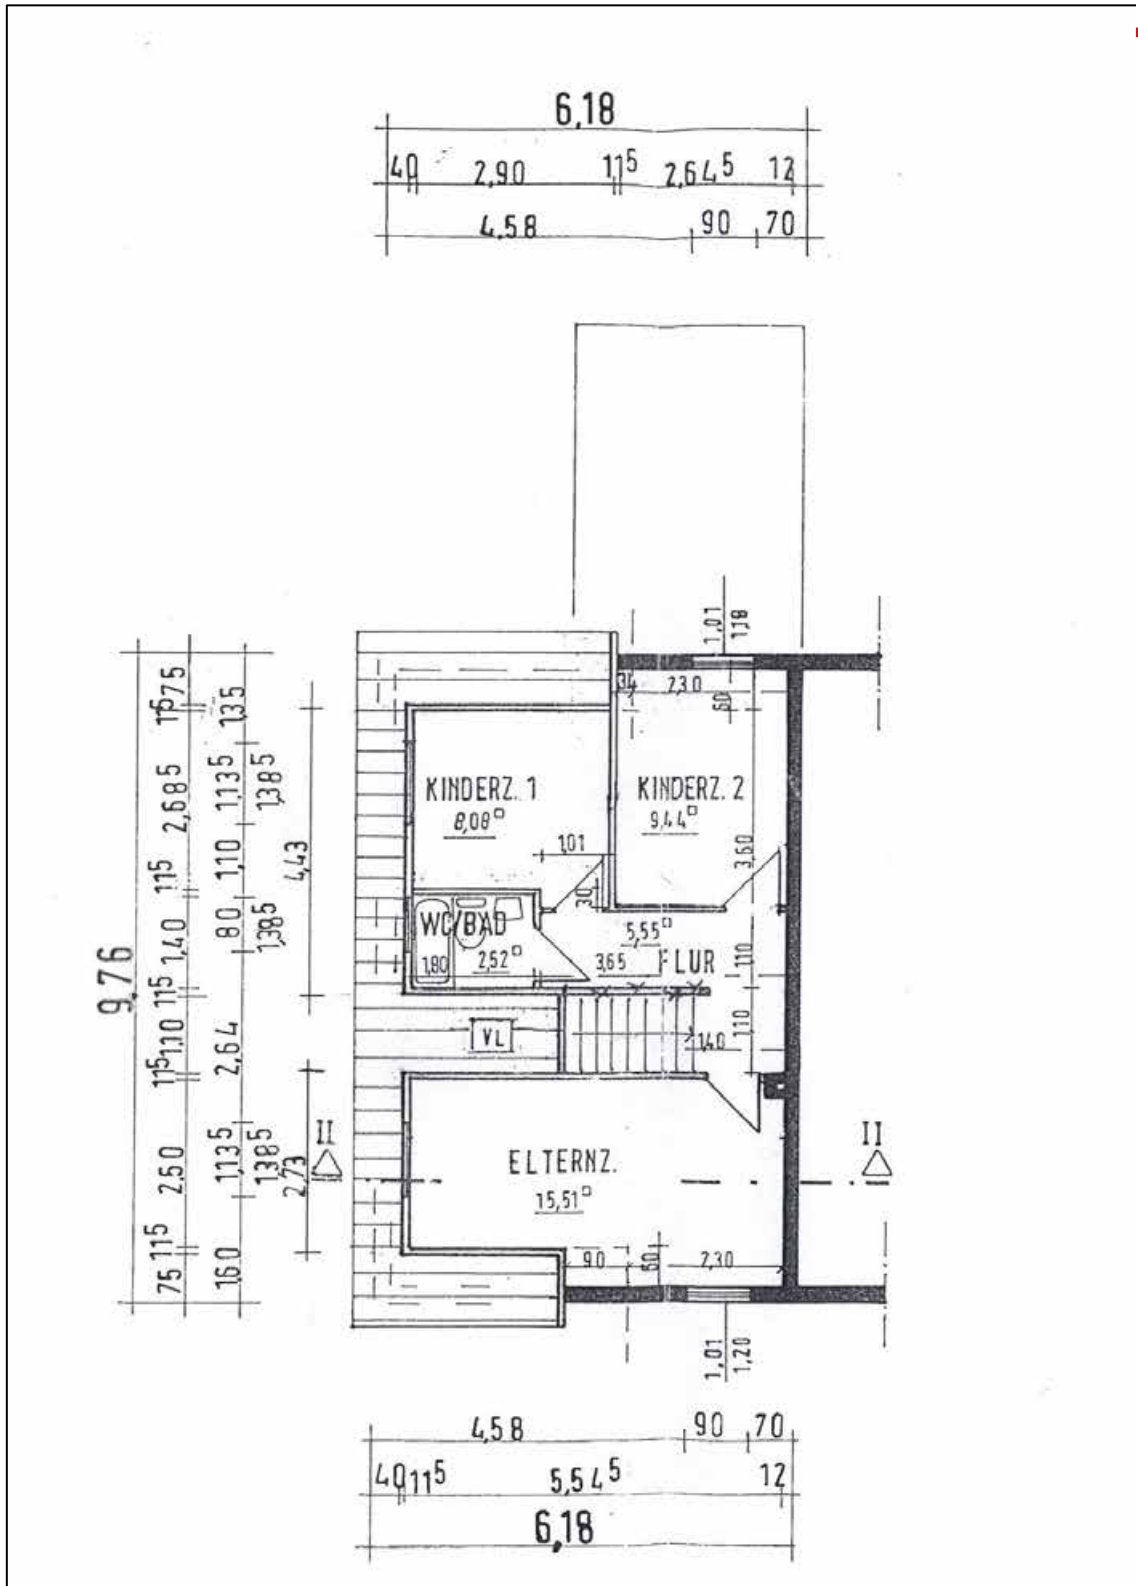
Dachgeschossgrundriss der Einfamilien-Doppelhaushälfte ohne Maßstab. Der ursprünglich geplante Dachgeschossausbau wurde lediglich in reduzierter Form durchgeführt, daher stimmt der Plan mit der Ist-Situation nur bedingt überein.
